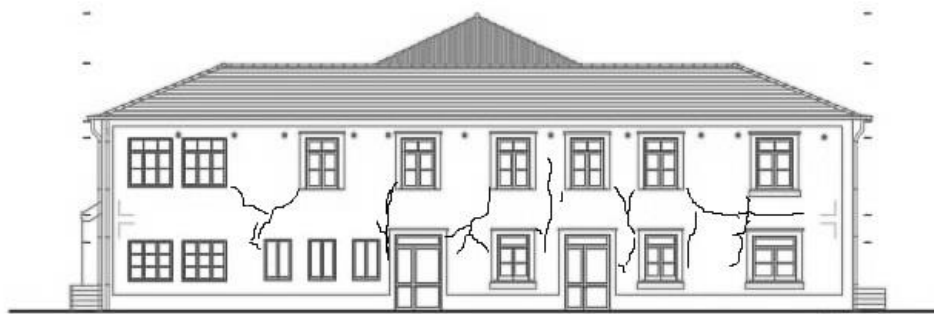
mapeamento das fissuras – alçado principal
